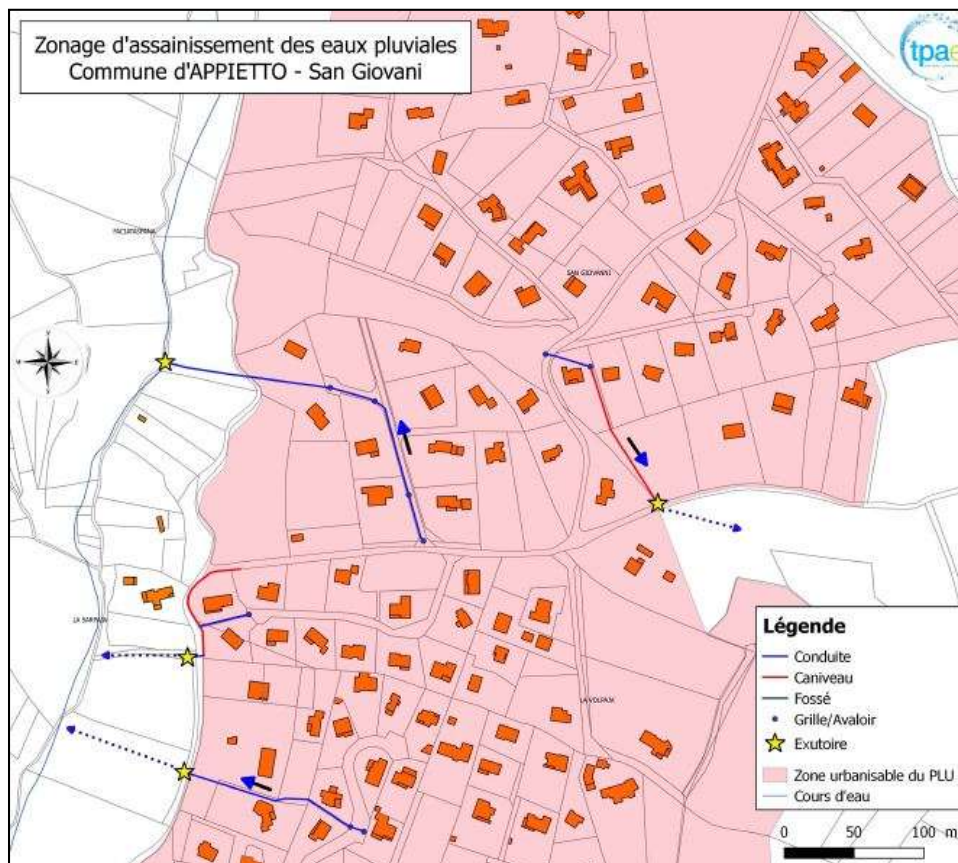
Plan du réseau pluvial du hameau San Giovanni
